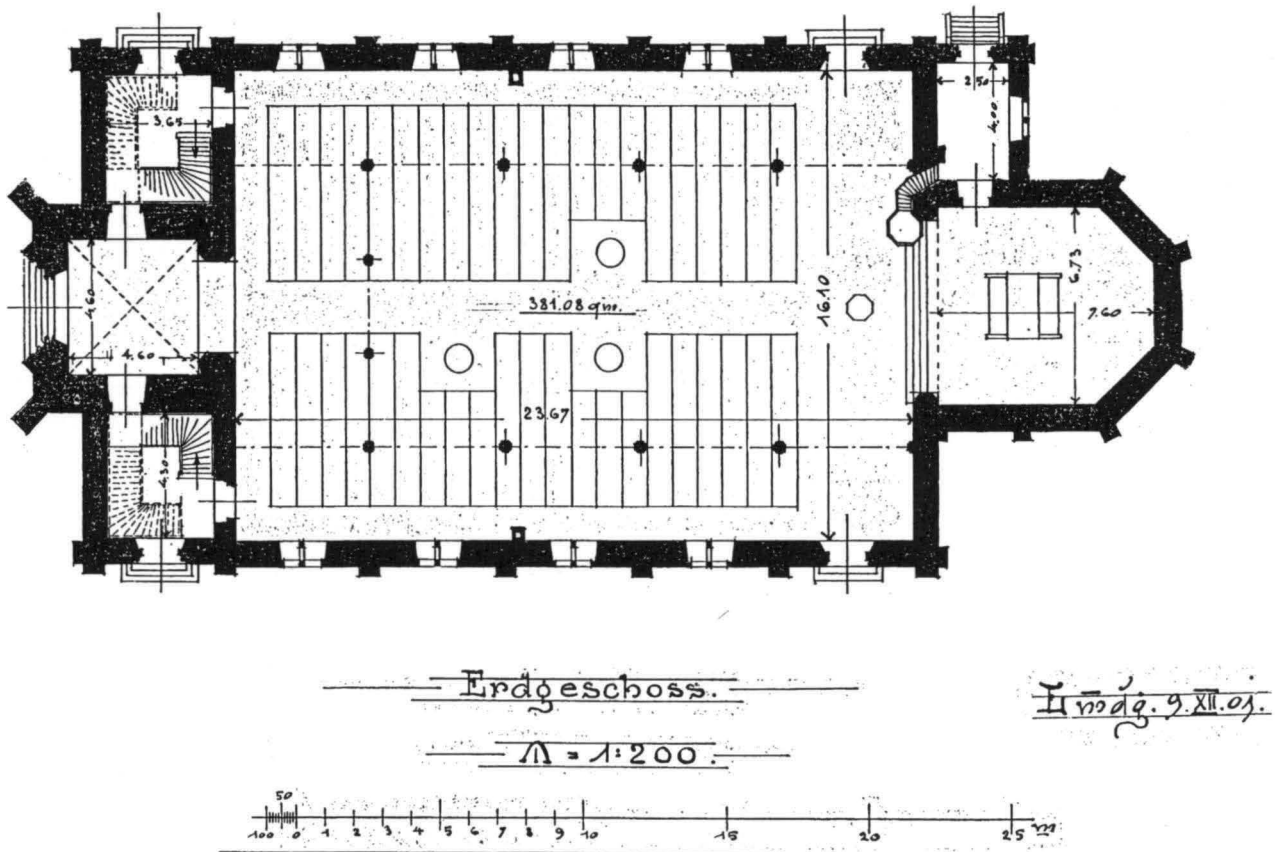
Erdgeschoss-Grundriss 1861 von Arnold mit veränderter Inneneinrichtung 1901
